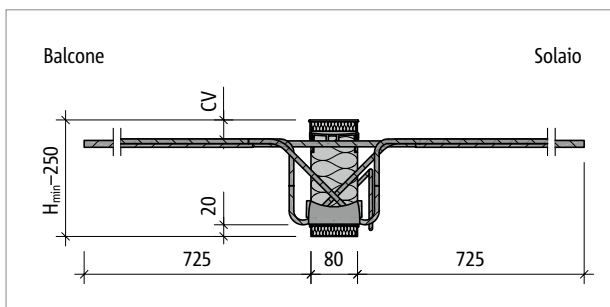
Schöck Isokorb® T tipo K-M6-VV1: sezione del prodotto
